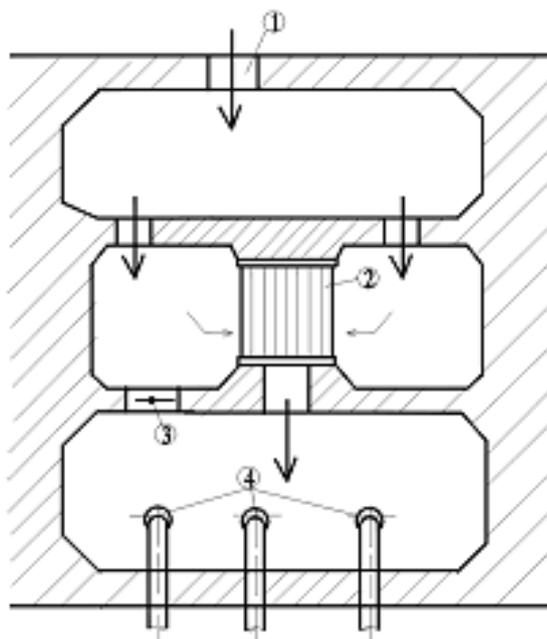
Схема установки сіток з внутрішнім одностороннім підводом води
